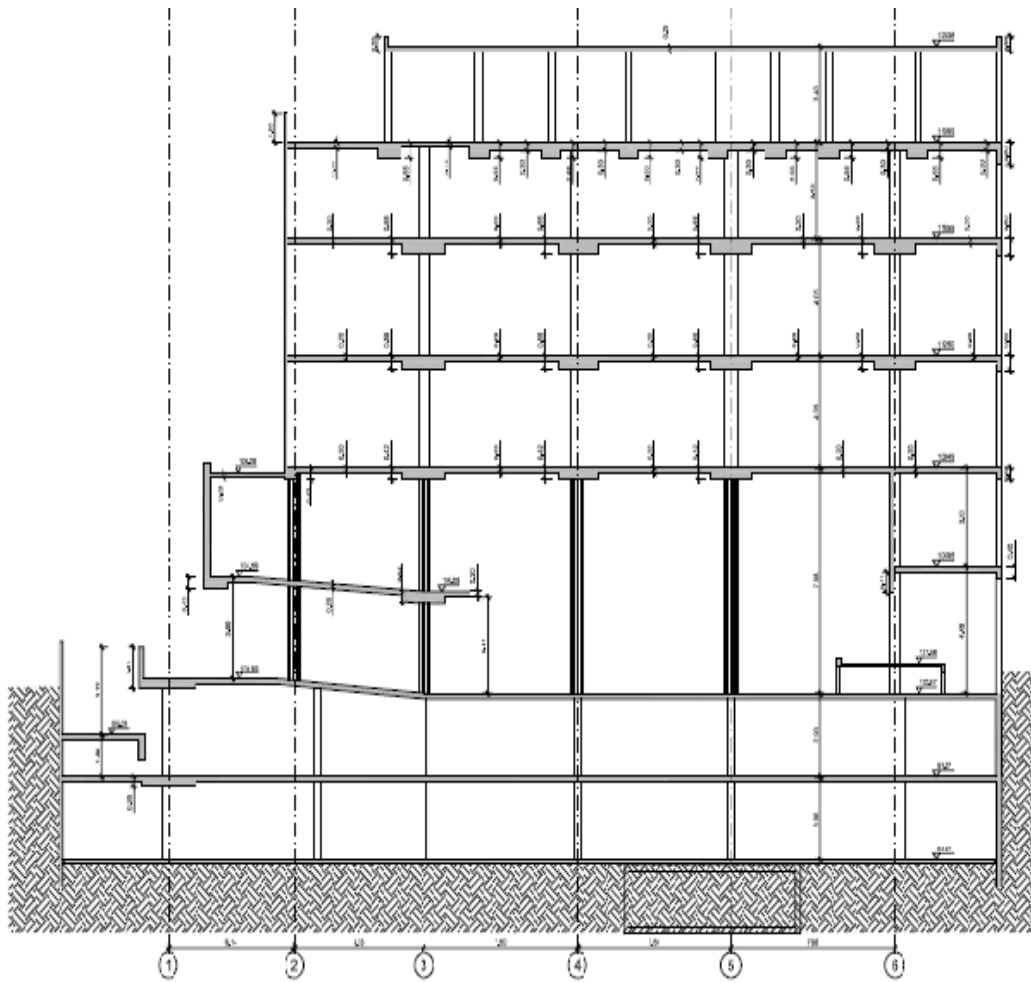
CORTE TIPO I DA ESTRUTURA - LONGITUDINAL (AUTOCAD)
